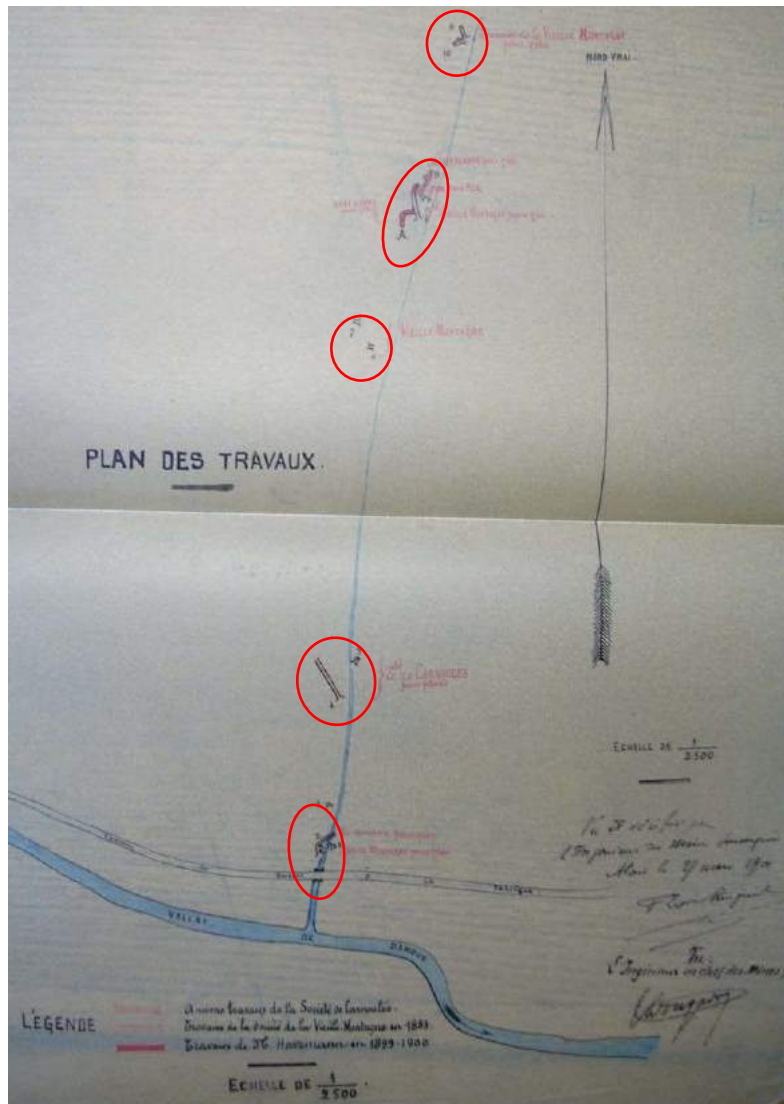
Plan des travaux de recherche dans le ravin des Combettes (source : plan SDM d'avril 1901, Archives Nationales - 1901-04-29 rapport SdM Chabaud)
